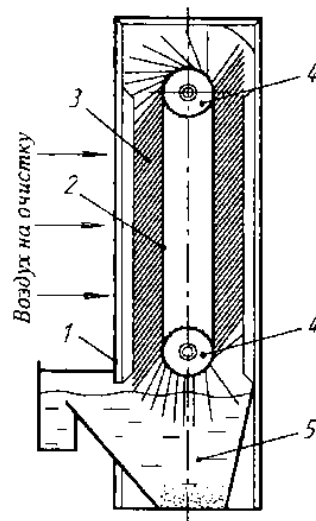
Самоочищающийся масляный фильтр: 1—корпус; 2—цепь; 3—шторки; 4—шестерни привода; 5—масляная ванна
